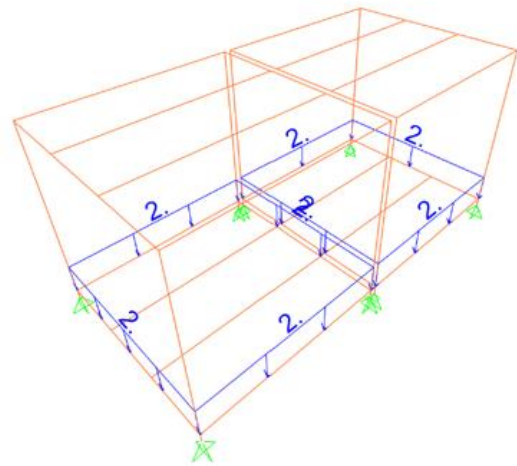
Cargas a las vigas. Fuente: Elaboración propias
